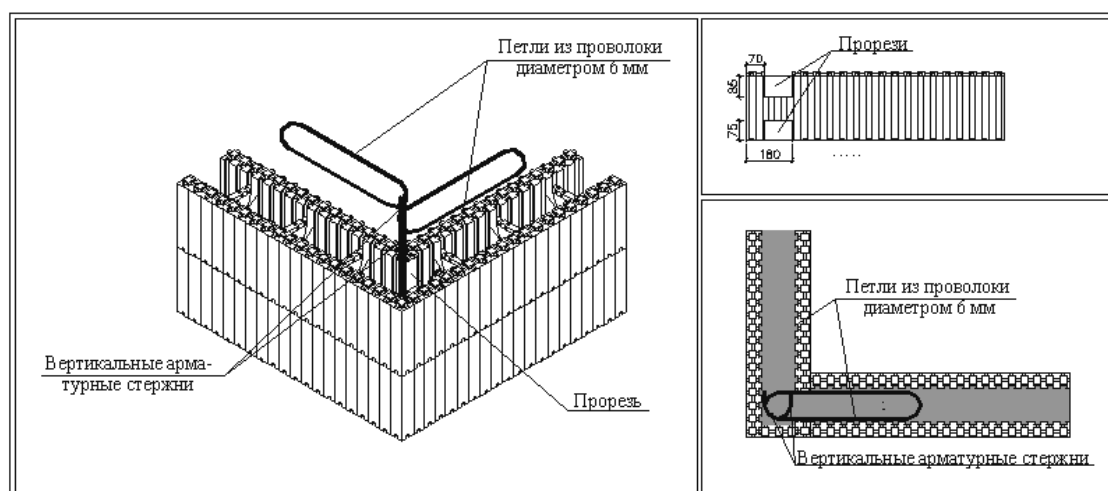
Конструкция угла стены из элементарных пустотелых блоков
